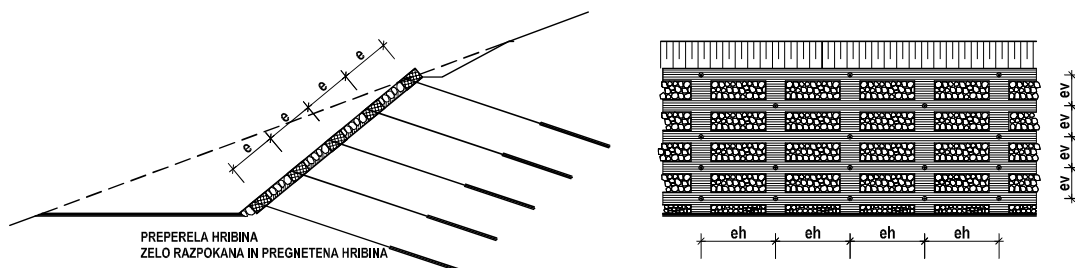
Sidrani slopi in grede – branasta konstrukcija
